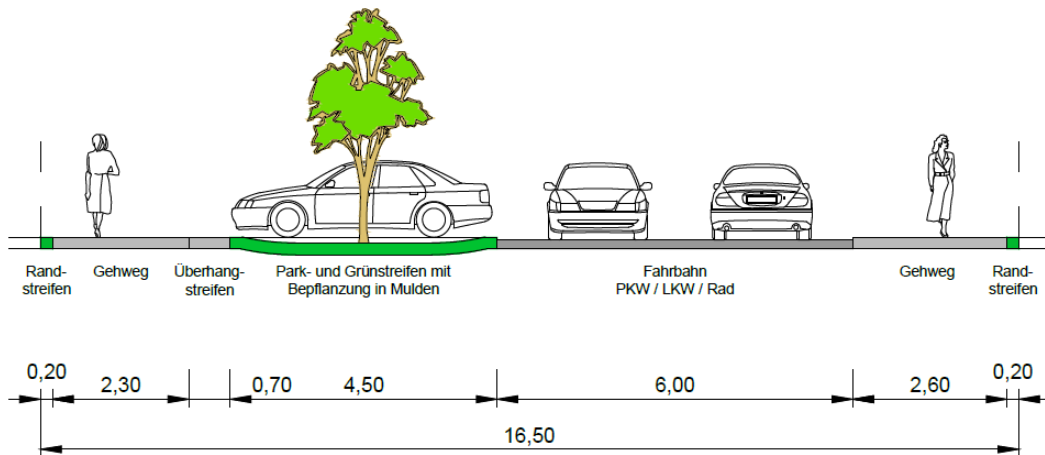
Straßenquerschnitt „Planstraße A“, ohne Maßstab
